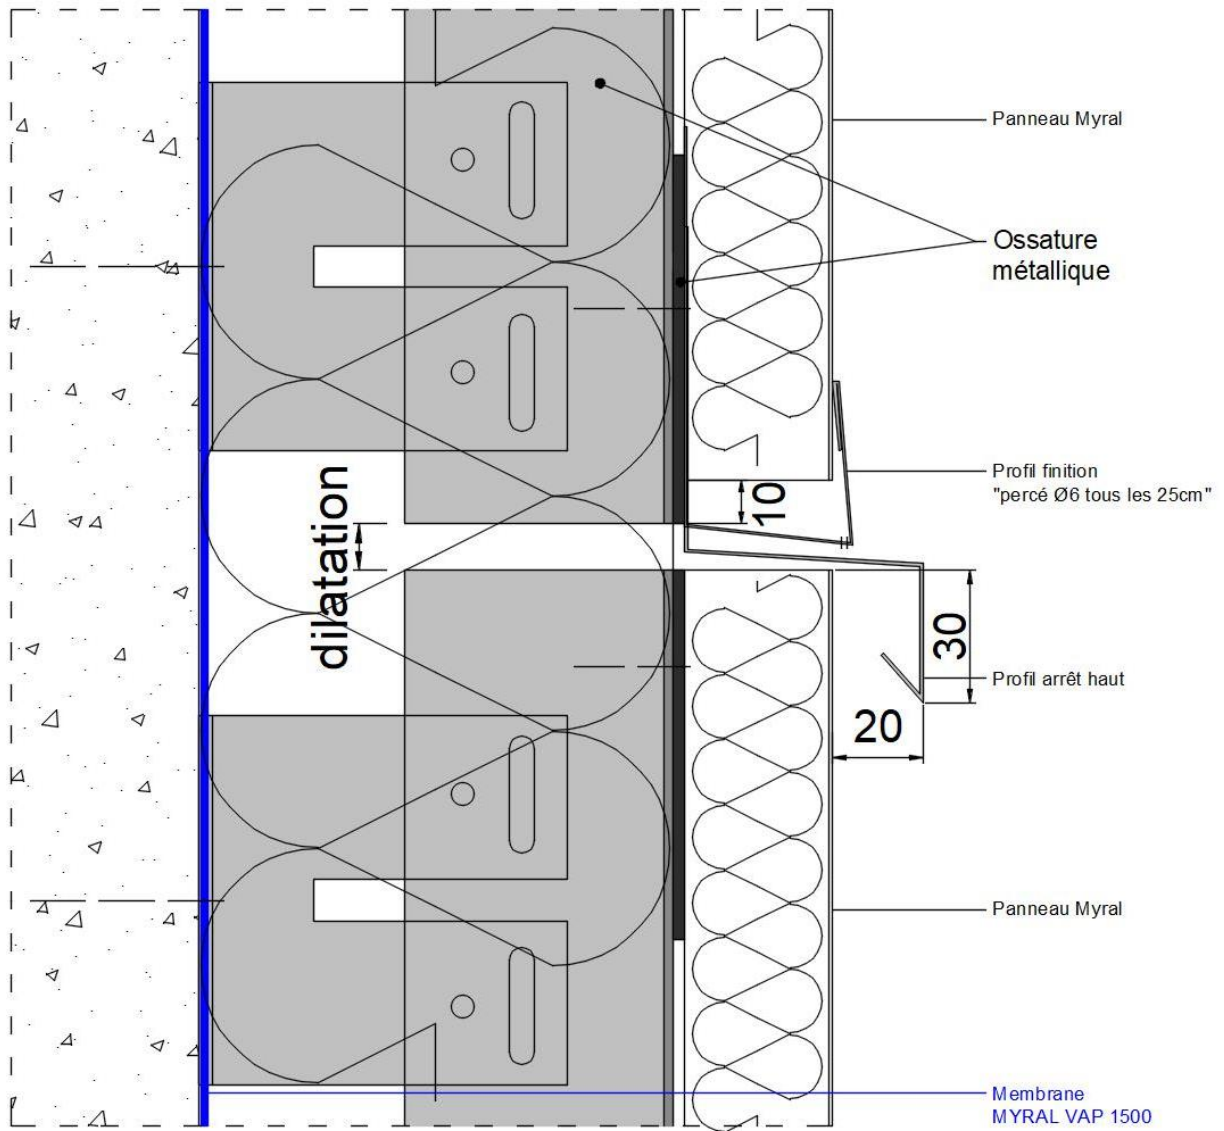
Raccord horizontal avec profils – Coupe verticale
